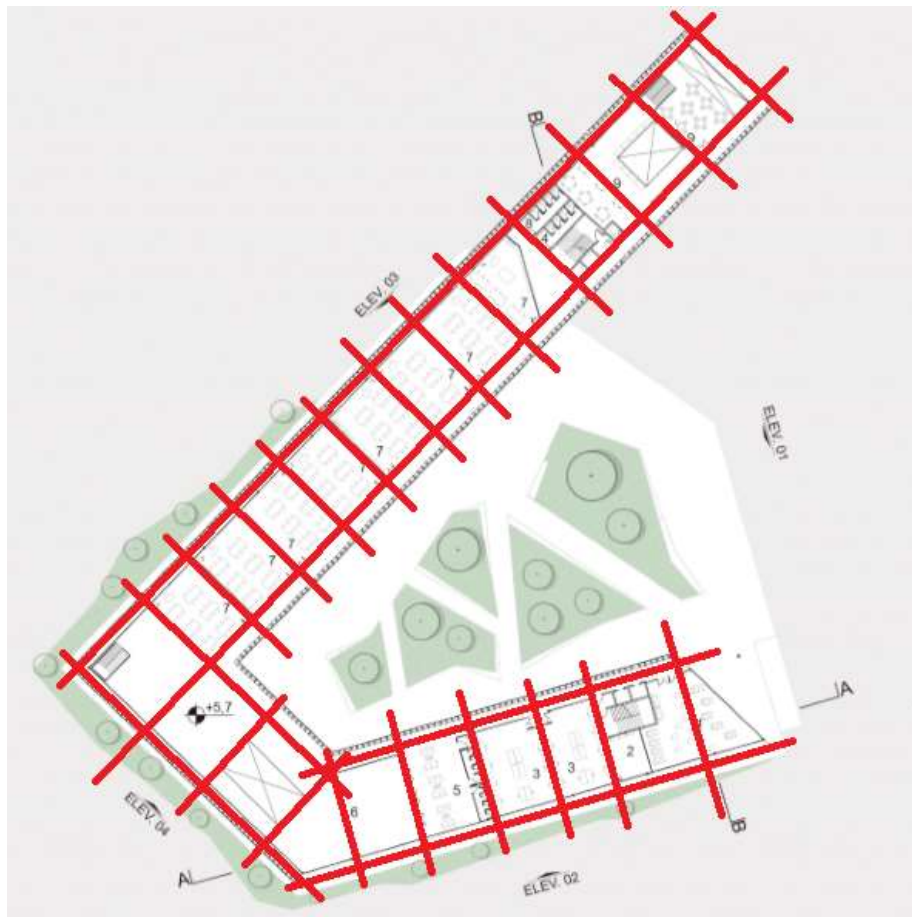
Representação do padrão estrutural do segundo pavimento.
